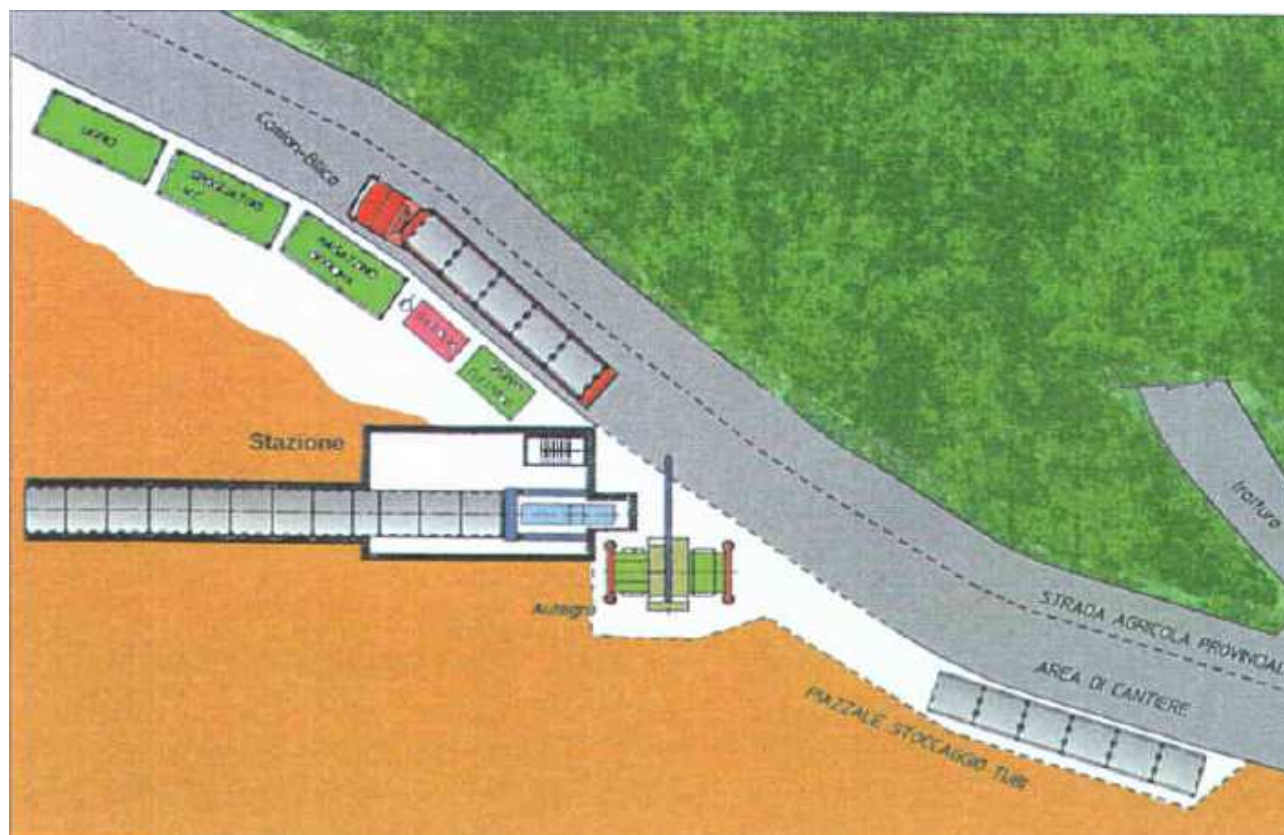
Schema tipo di una cantiere per l'installazione di un microtunnel.
